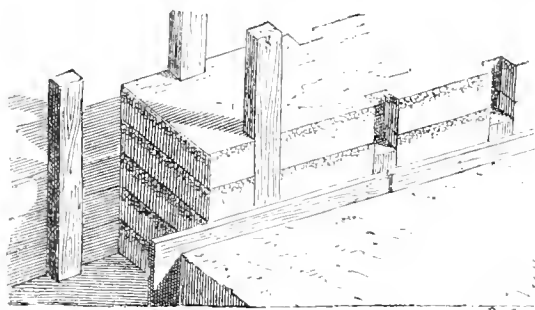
Mur en caementum construit dans une forme en bois.
